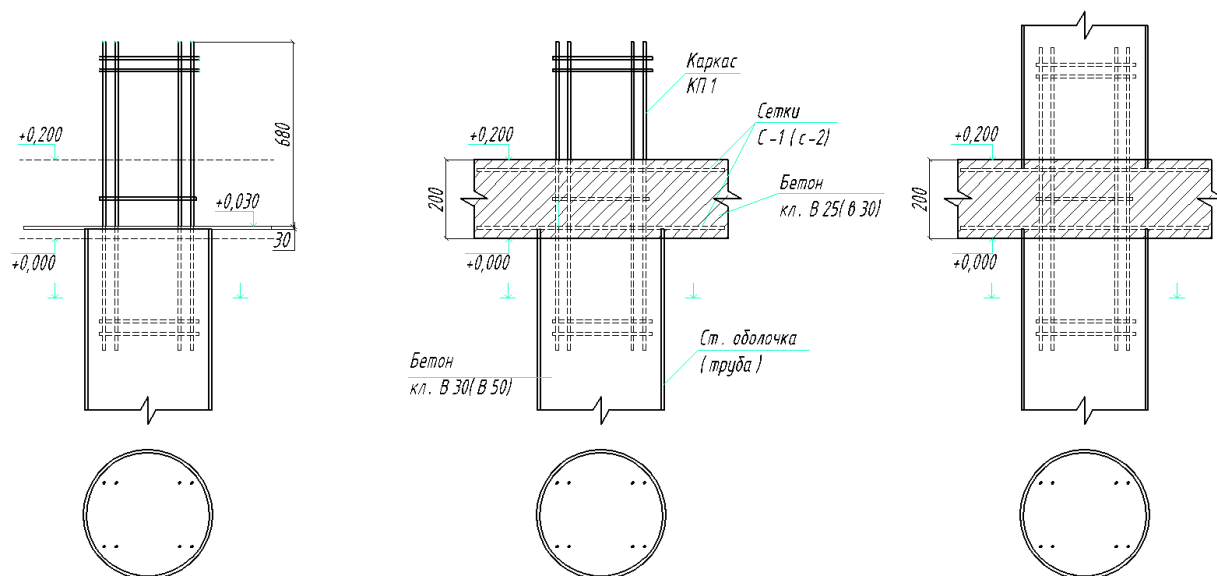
Фрагмент стыка колонны с плитой монолитного перекрытия [3]
